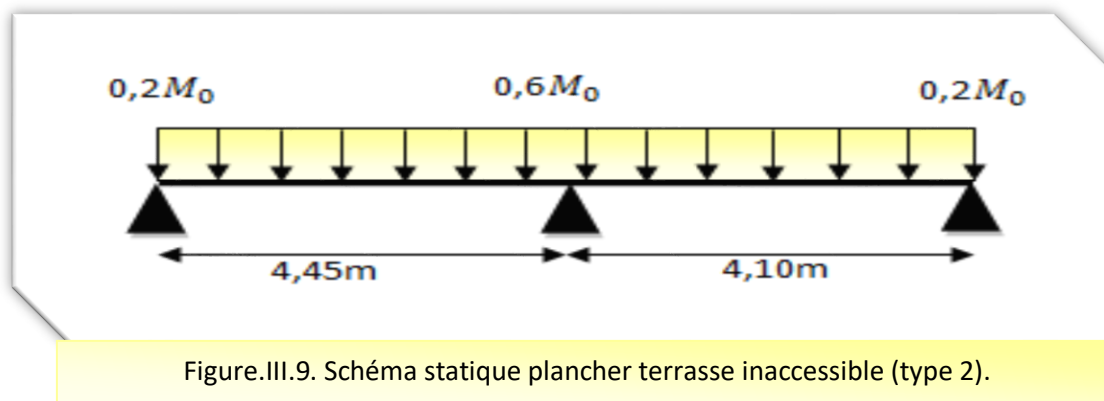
Schéma statique plancher terrasse inaccessible (type 2).
